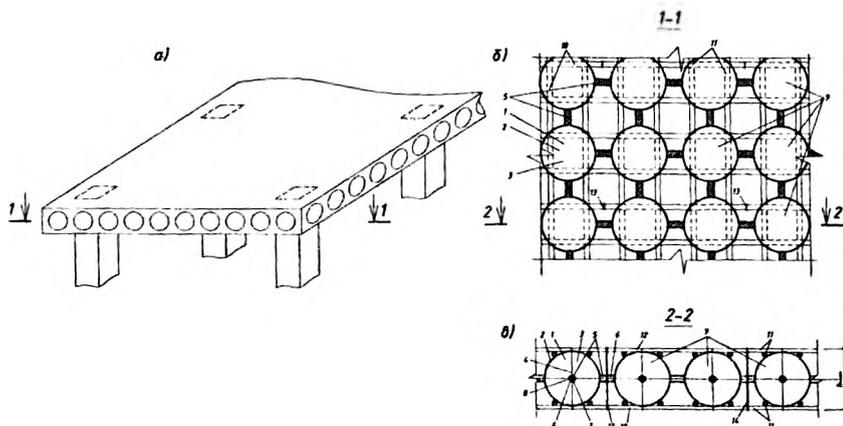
Конструктивное решение безбалочной плиты перекрытия:
